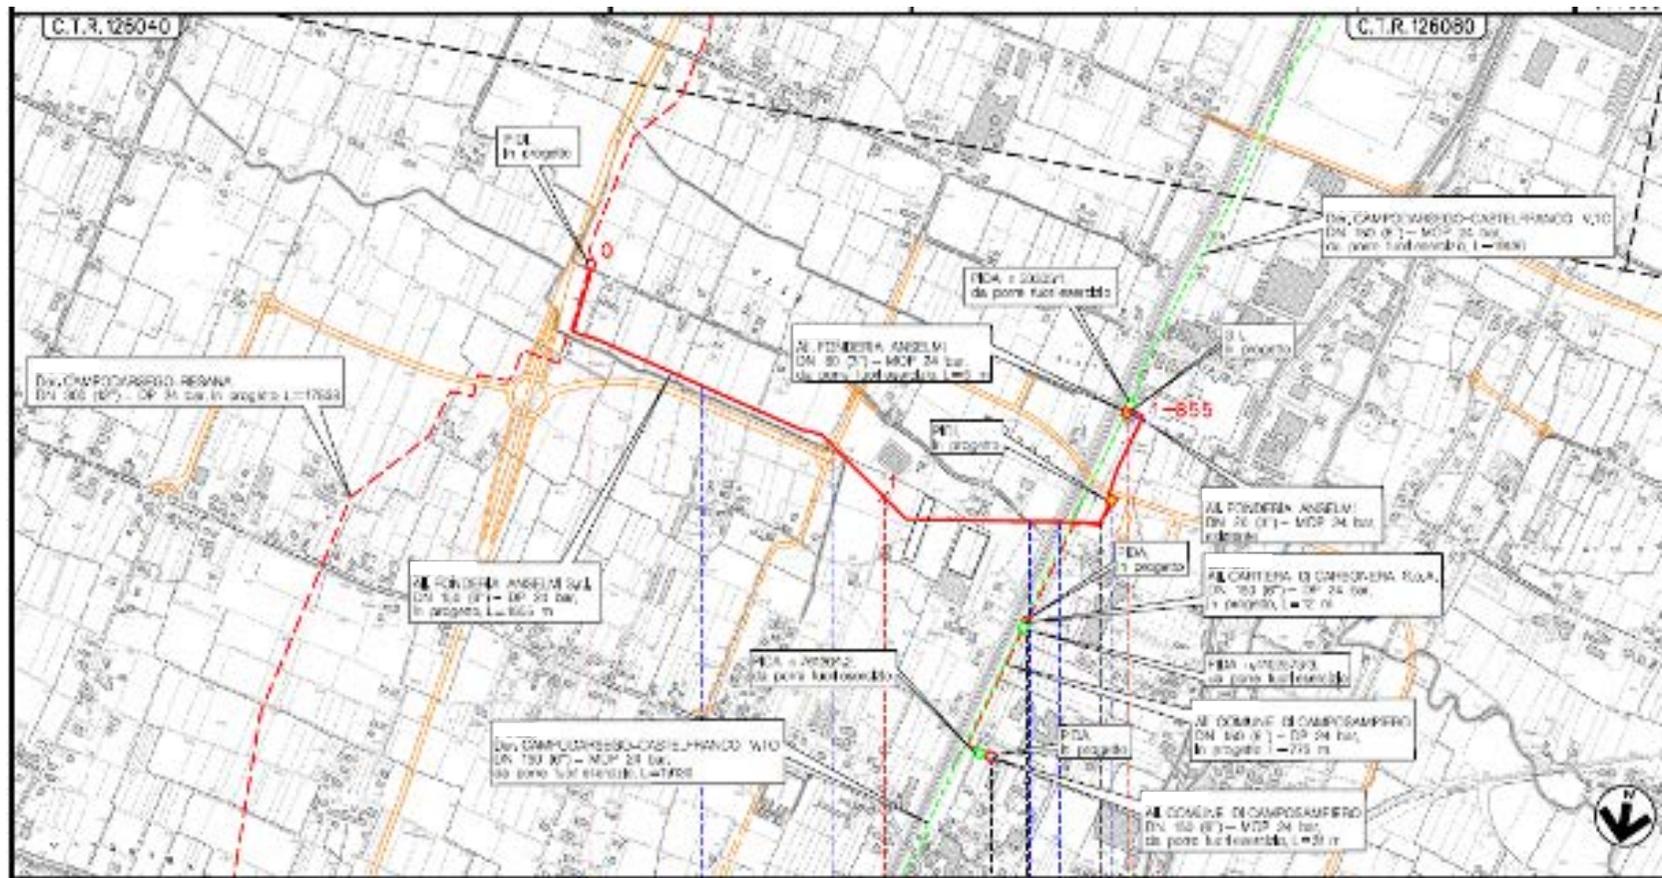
RIF. ALL. Fonderia Anselmi SRL - Stralcio planimetria CTR con localizzazione dell'area di intervento
